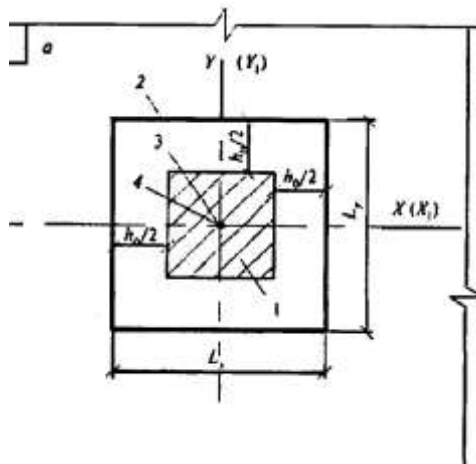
К расчету опорного сечения ригеля на продавливание.
